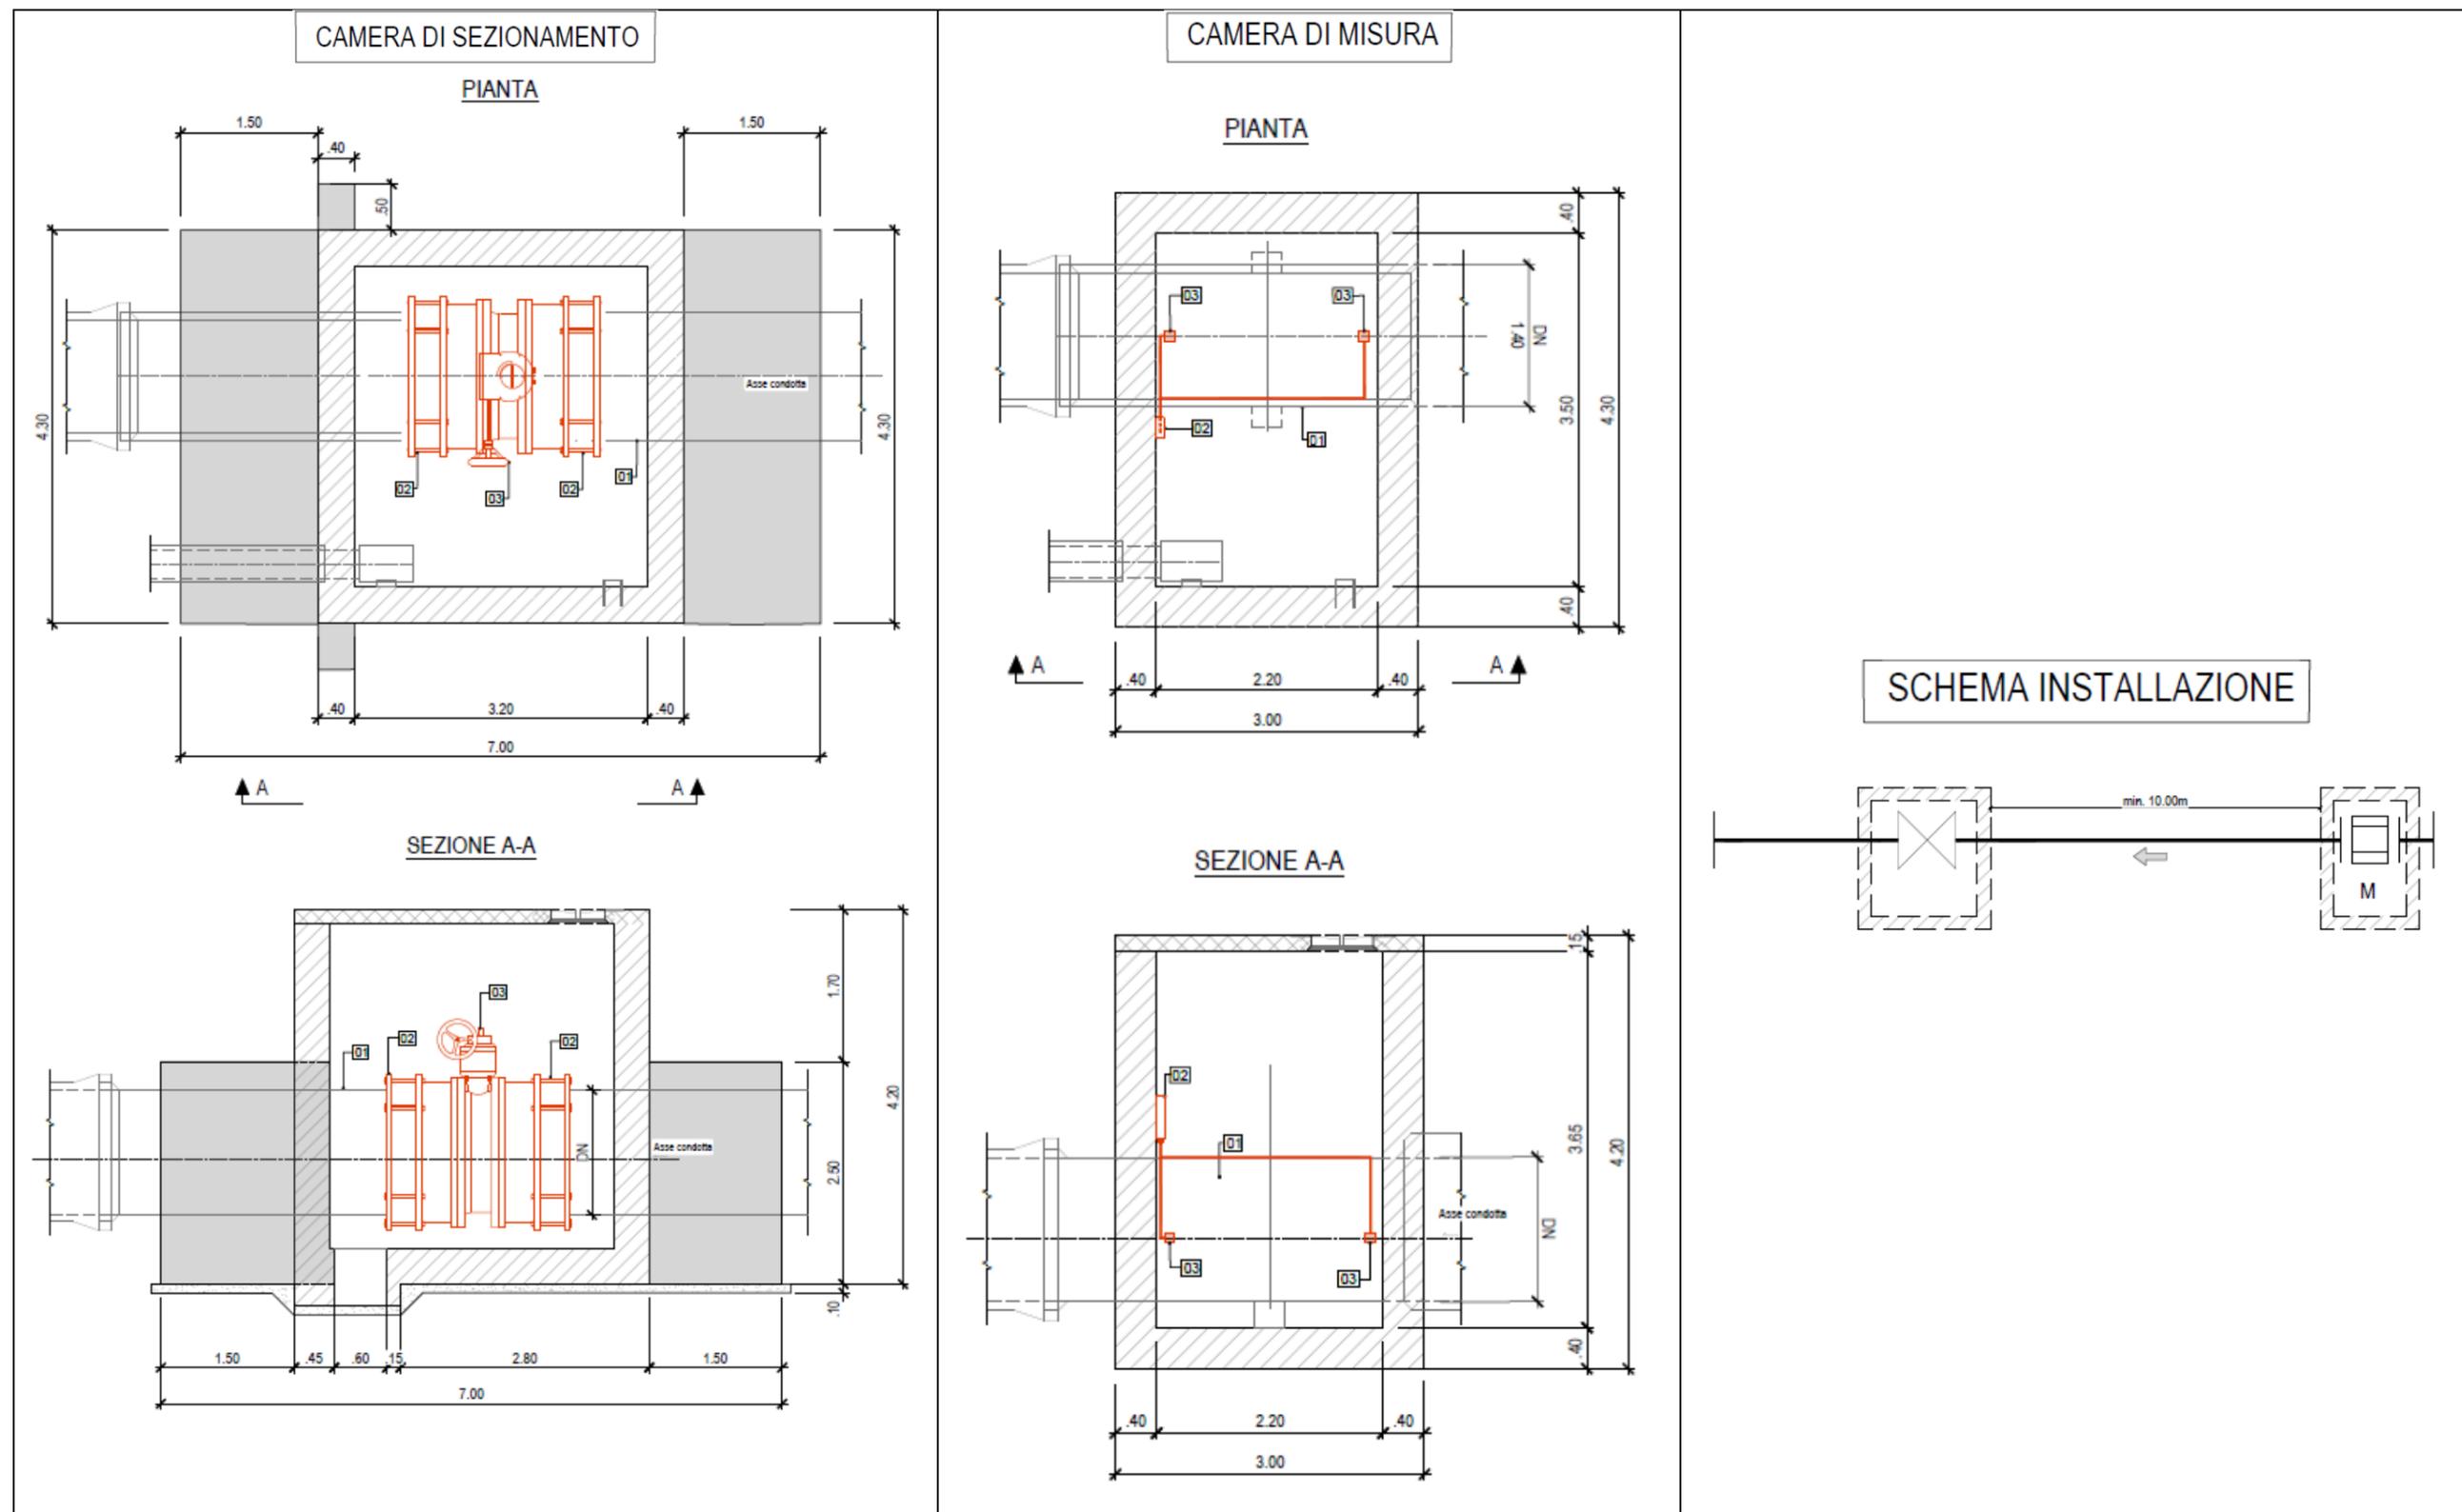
Schema tipo delle nuove camere di sezionamento e misura, con schema di installazione.
